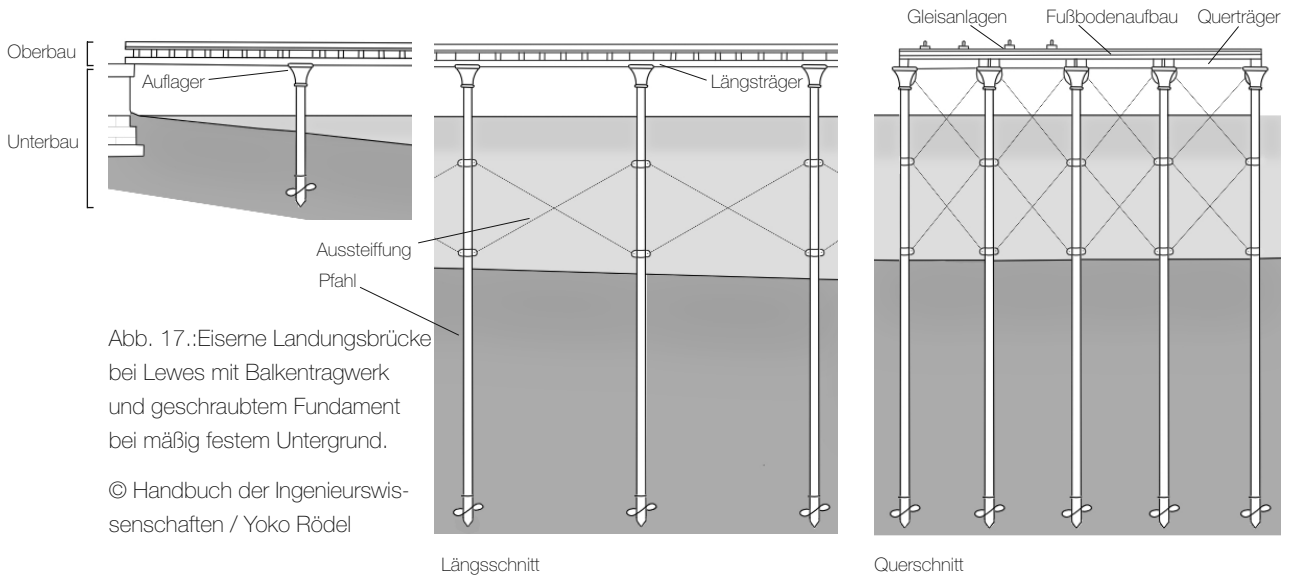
Eiserne Landungsbrücke bei Lewes mit Balkentragwerk und geschraubtem Fundament bei mäßig festem Untergrund.
